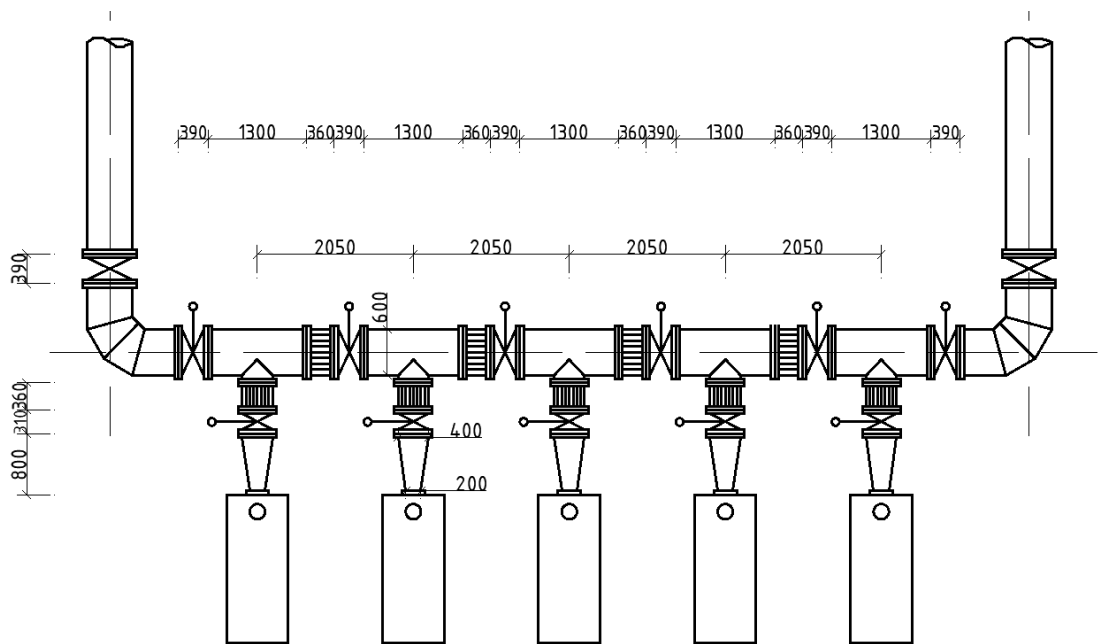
Схема розташування всмоктувальних трубопроводів всередині насосної станції
